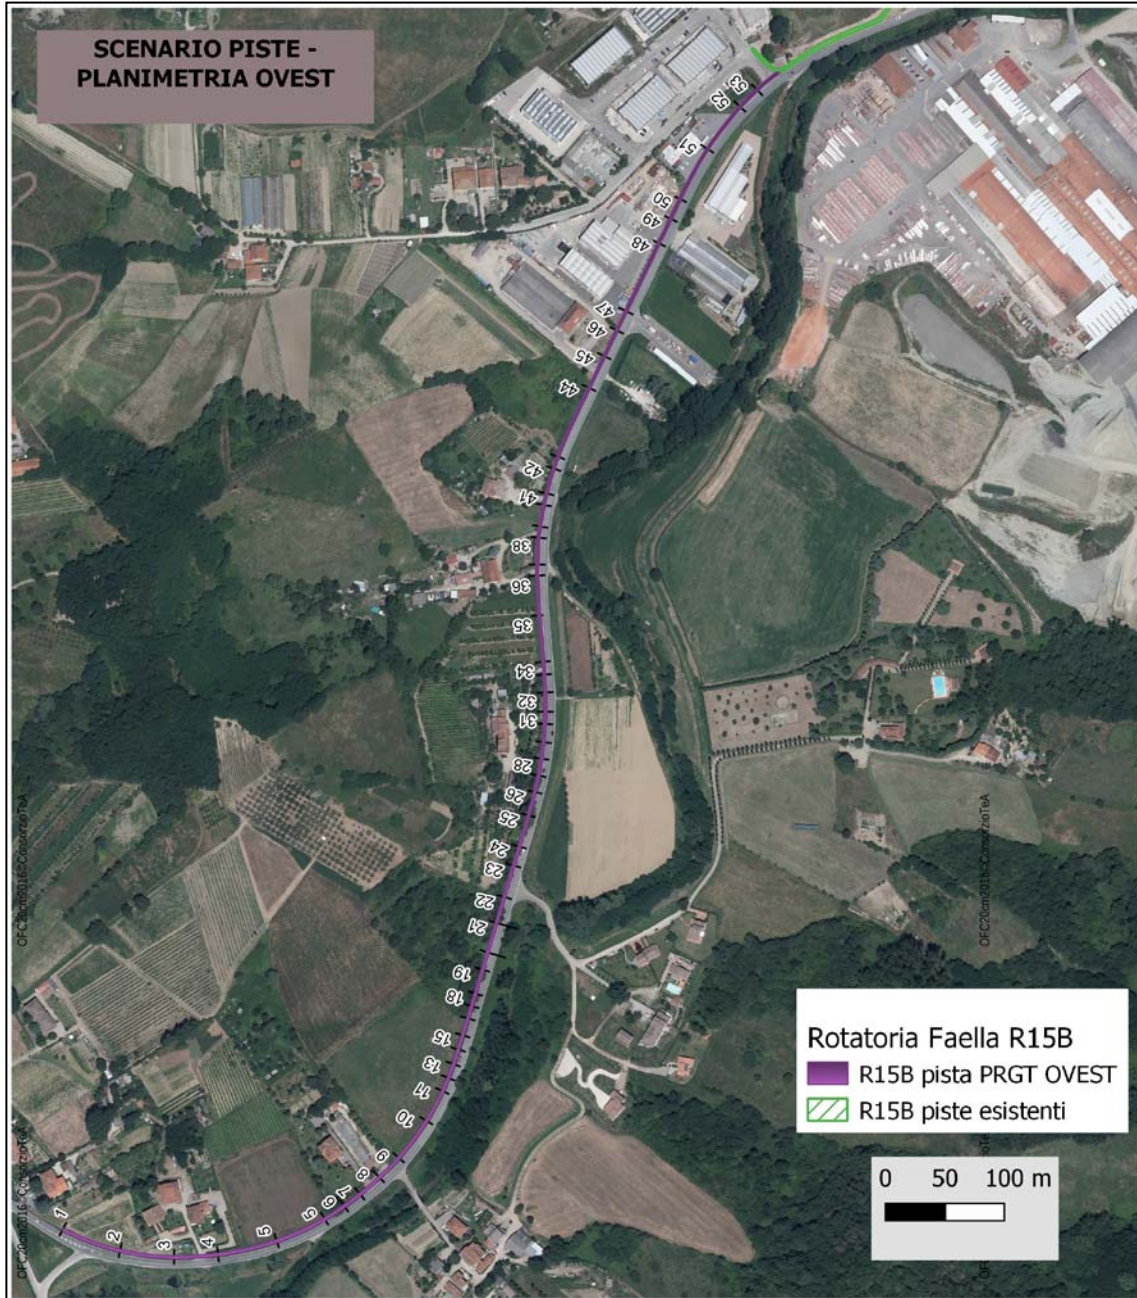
Planimetria scenario "B" piste quadro OVEST- sovrapposizione con ortofoto RT2010.
